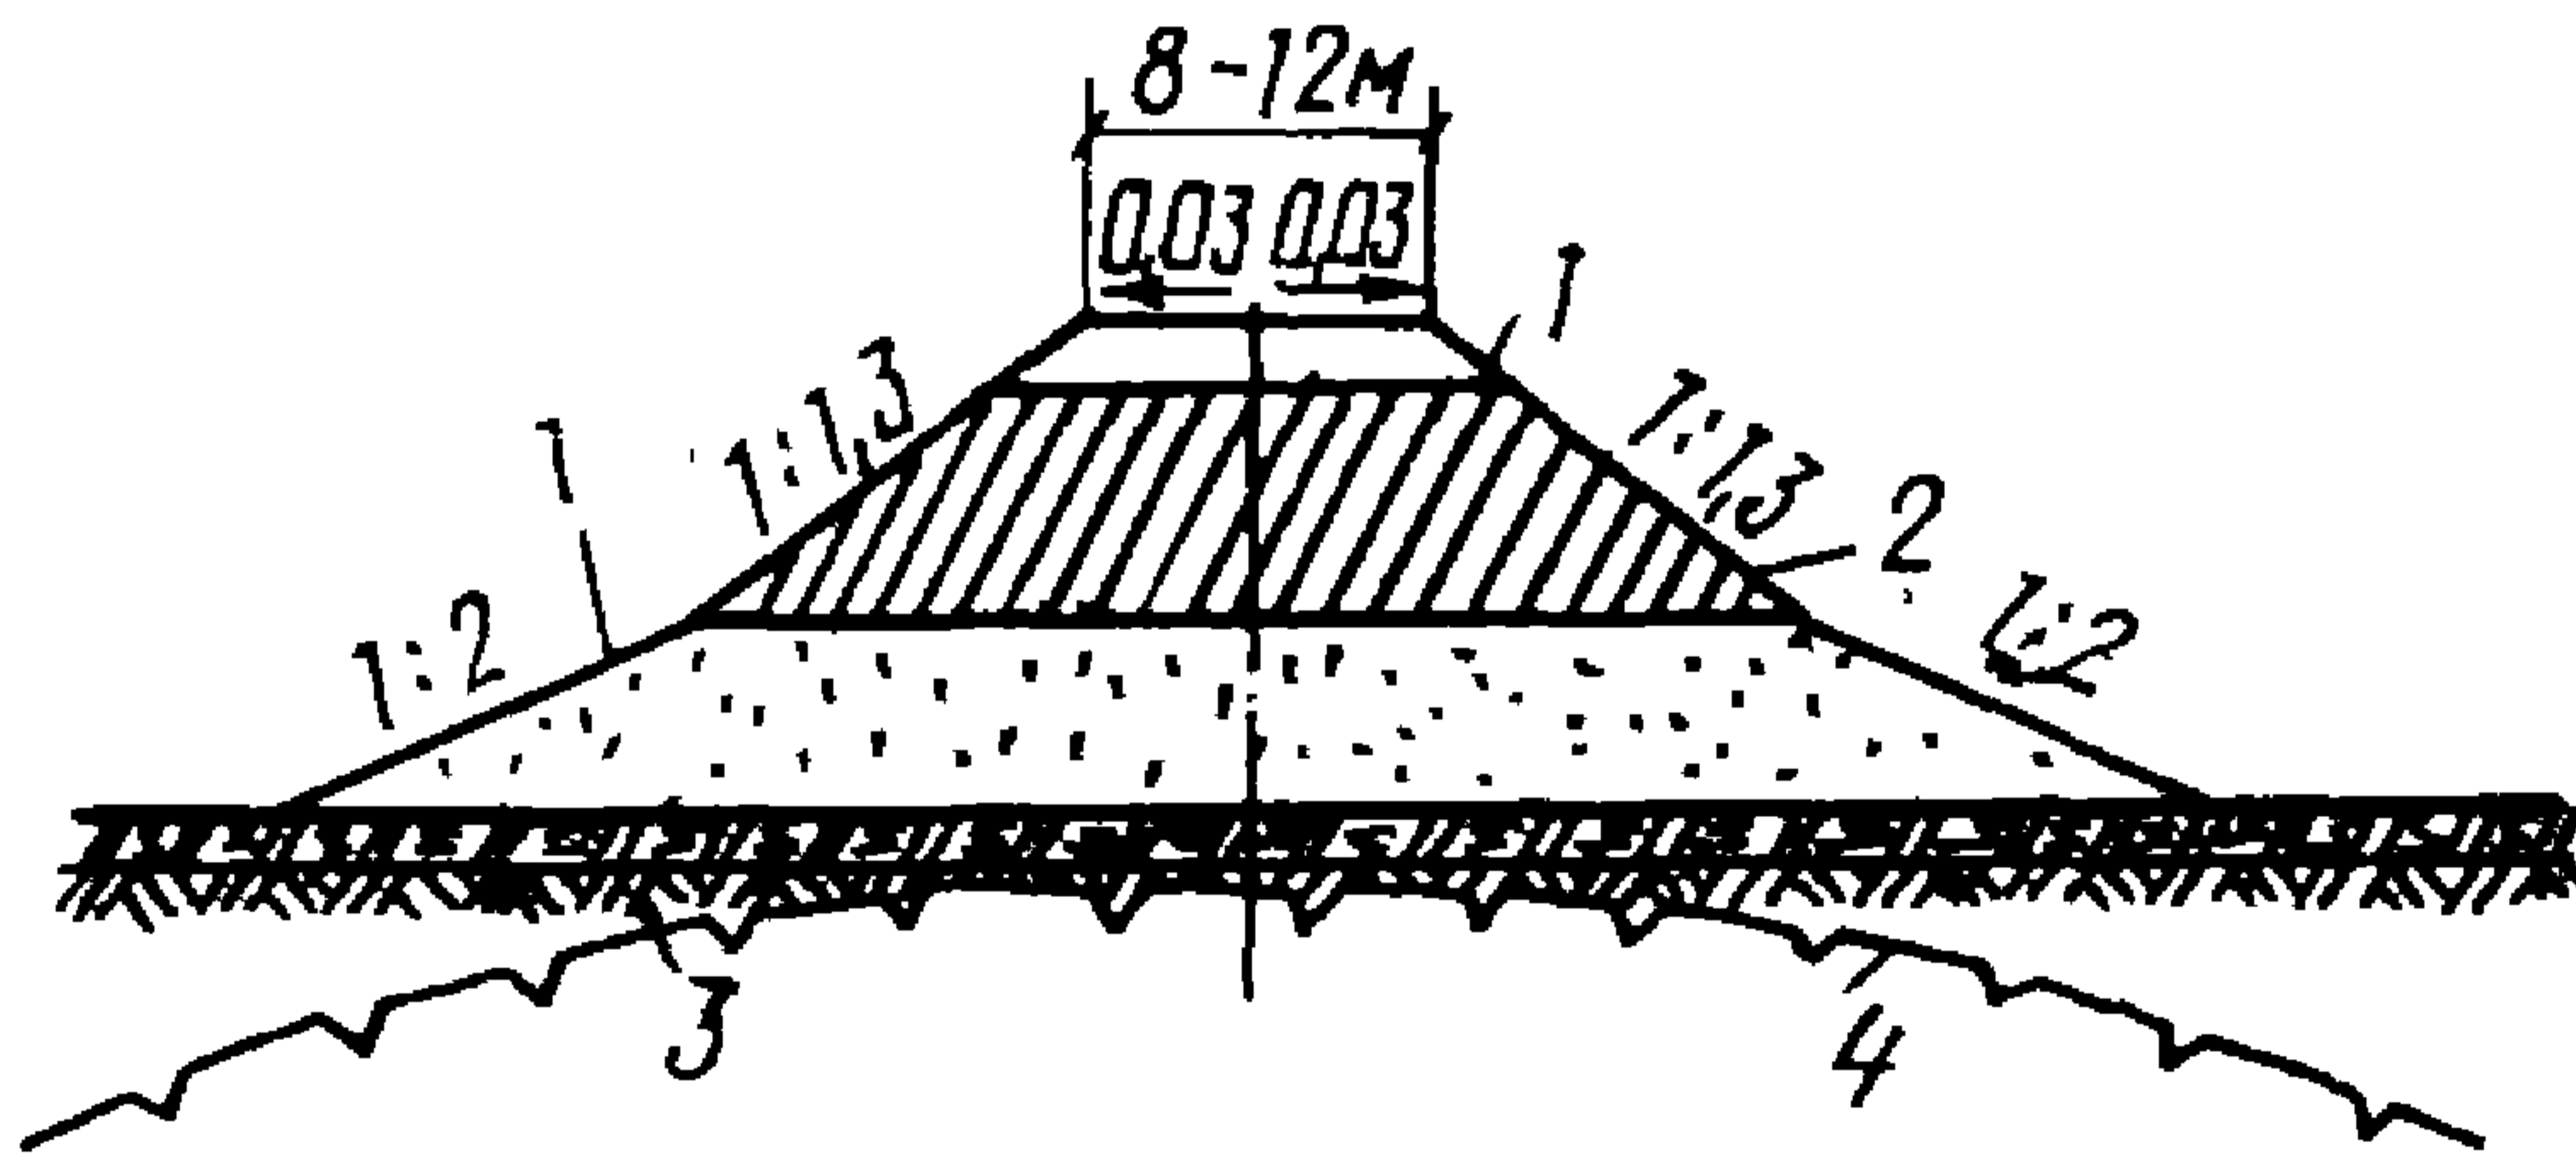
Поперечный профиль насыпи, возводимой в две стадии, на участках второй группы ландшафтных комплексов при раздельной прокладке трубопровода и дороги:
